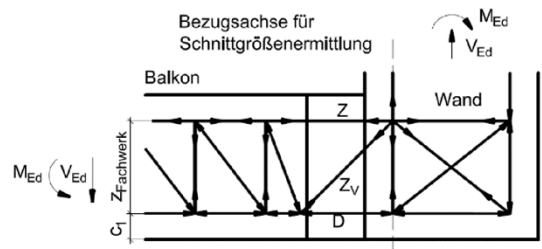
Schöck Isokorb® Typ K-U und K-U-F mit Anschluss an Wand
